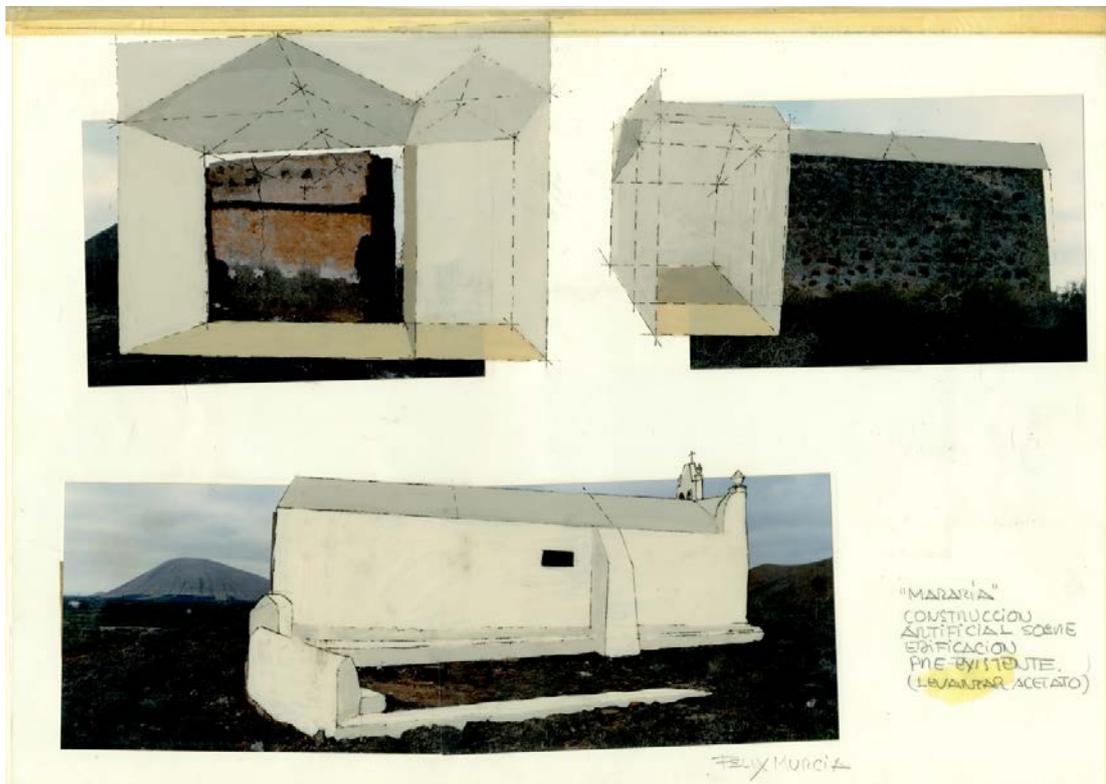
Boceto de detalles de los volúmenes a construir y el lateral, para la construcción de la ermita. Intervención sobre la fotografía anterior. Acetato con más tonos, pintado con gouache. DIN-A3.
